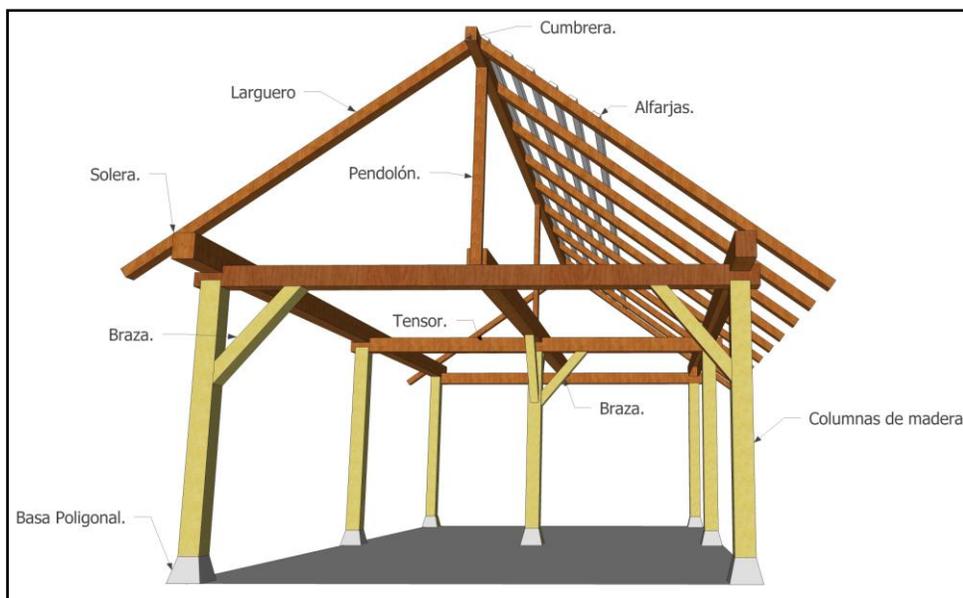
Pórticos de las viviendas y Estructura del la Cubierta.
